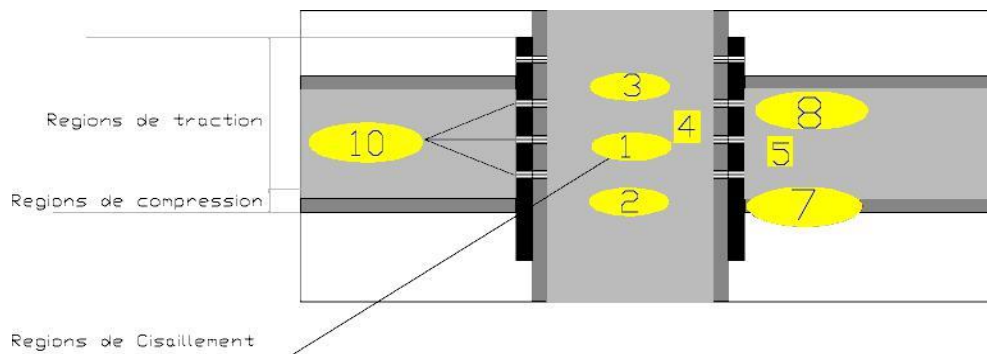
régions et zones d'un assemblage de type (poutre-poteau)
